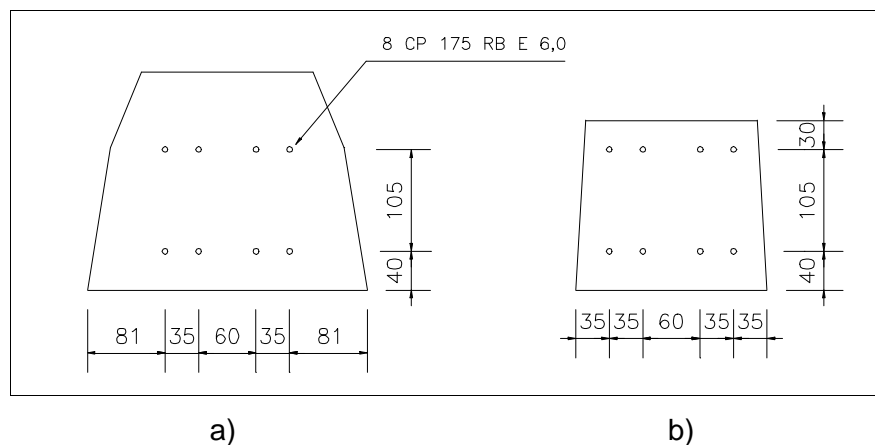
Armadura de protensão para a primeira modificação no dormente original:
